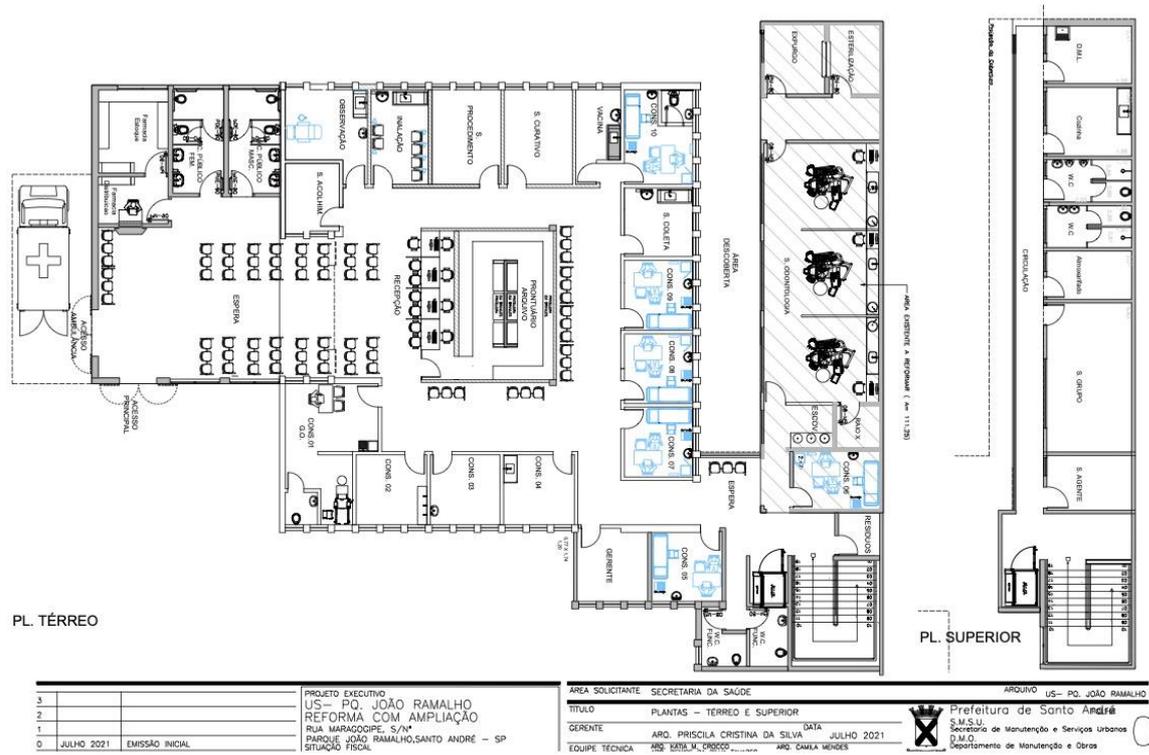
US João Ramalho. Planta do pavimento térreo e da ampliação no piso superior.
